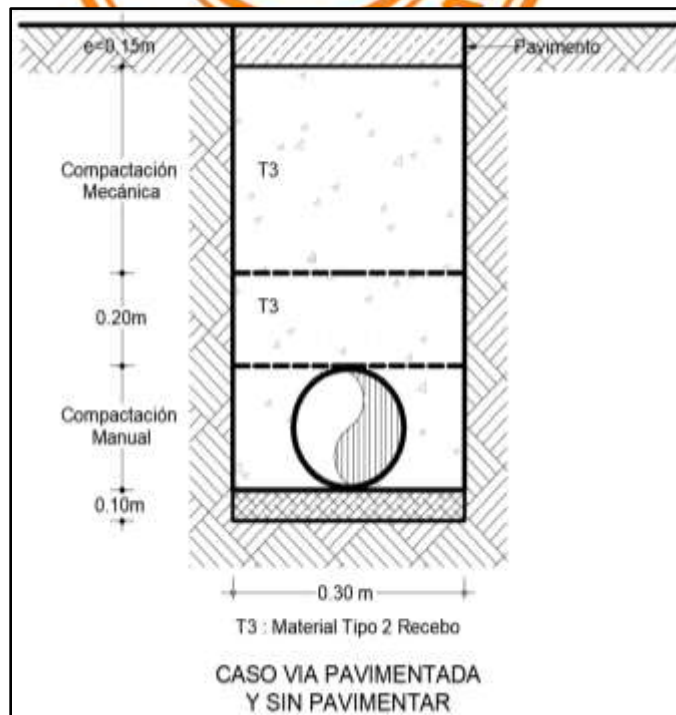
Relleno De Zanjas Para Acometidas De Acueducto Y Alcantarillado
